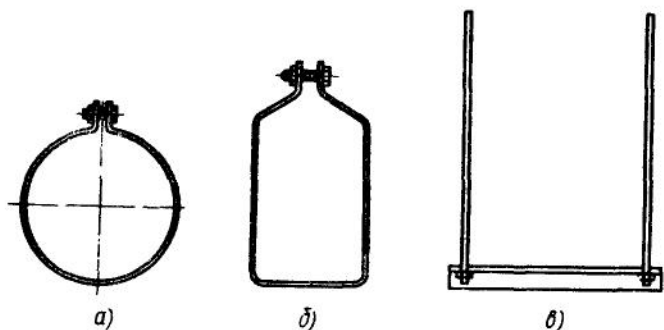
Хомуты для круглых (а) и прямоугольных (б) воздухопроводов и траверса (в)
